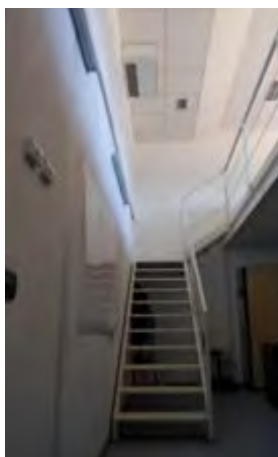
Interno degli uffici: accesso al soppalco.
